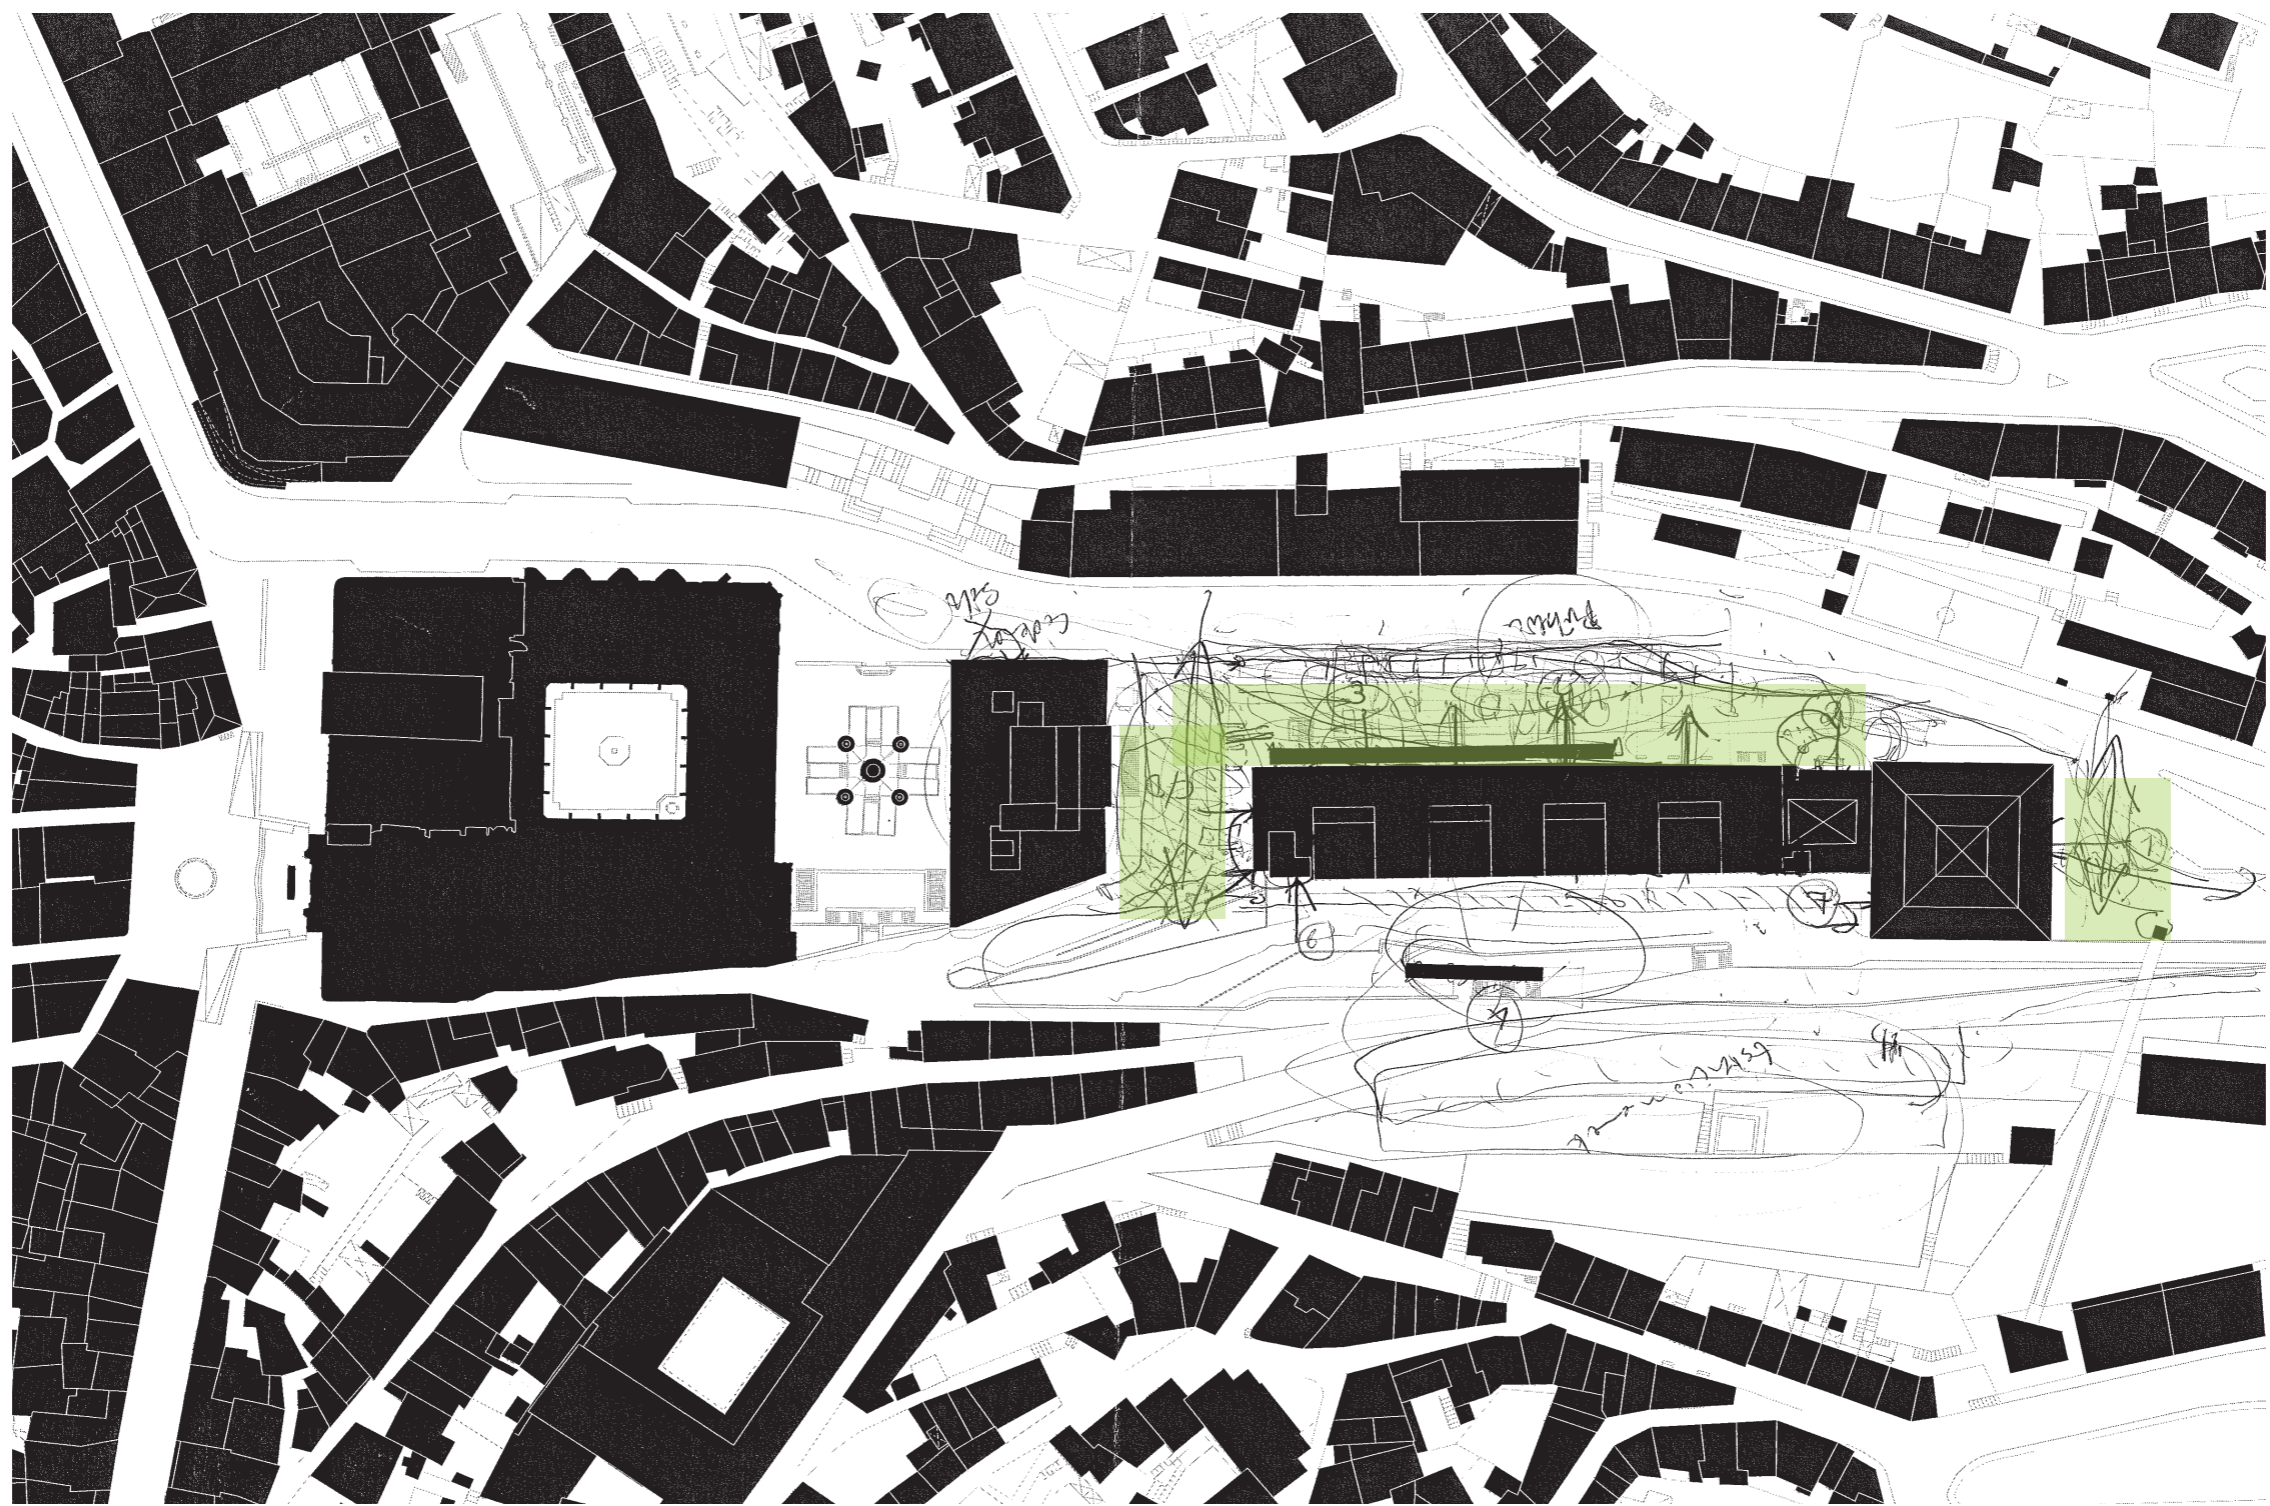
Planta de cidade e esquisso de pensamento - espaço verde no alçado norte. ©
